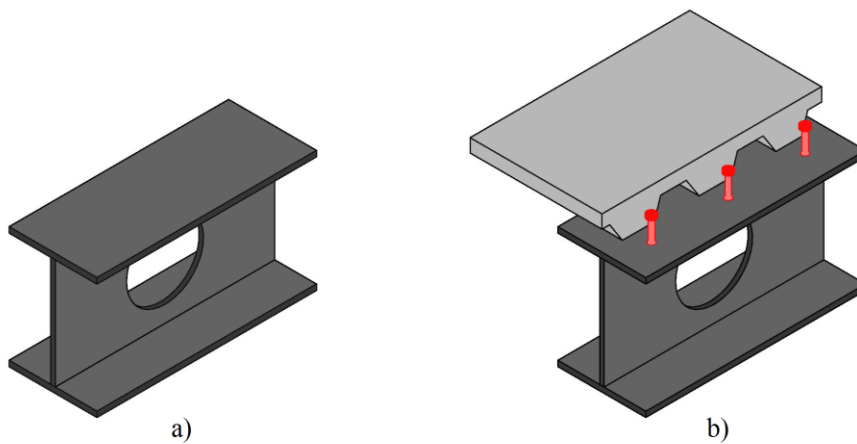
Vigas alveoladas: a) viga metálica; b) viga mista.
